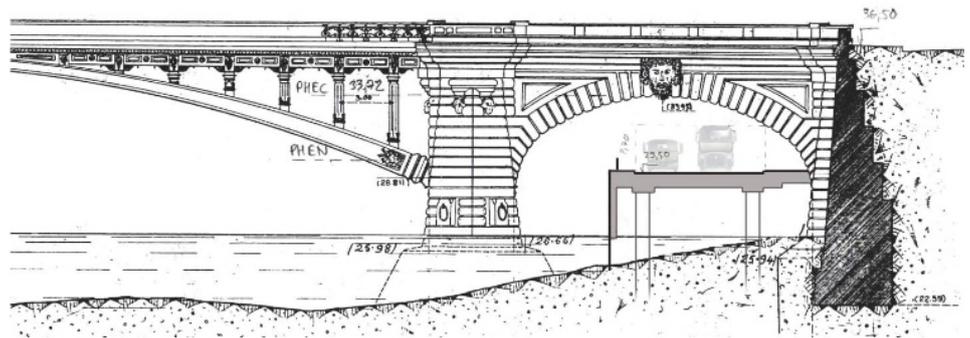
Coupe de la structure des quais en amont du pont Notre-Dame
